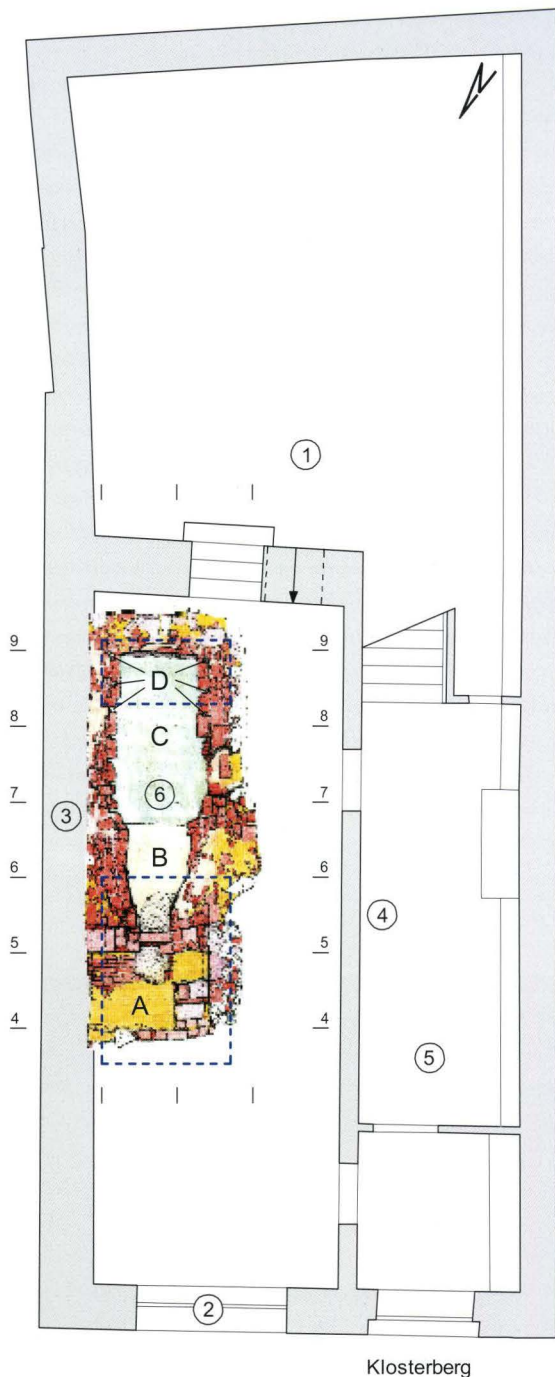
Klosterberg 21: Grundriss des vorderen Hausteils mit dem Ofenfundament. Die beiden rechteckigen Rahmen über dem Ofen bezeichnen die Bodenfenster aus Panzerglas, welche eine Besichtigung der Ofenfundamente ermöglichen. – Massstab 1:50. – Zeichnung: Christian Stegmüller.
